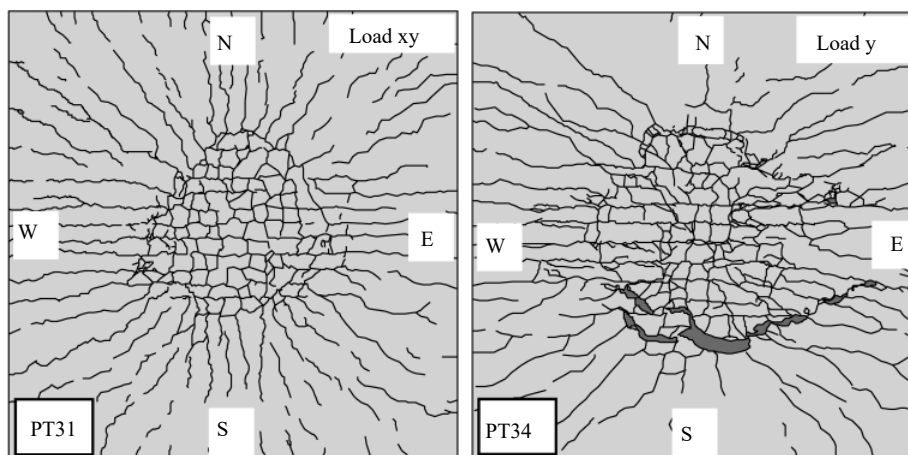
Padrões de fissuração de lajes ensaiadas à punção ([TASSINARI *et al.*, 2011](#))
